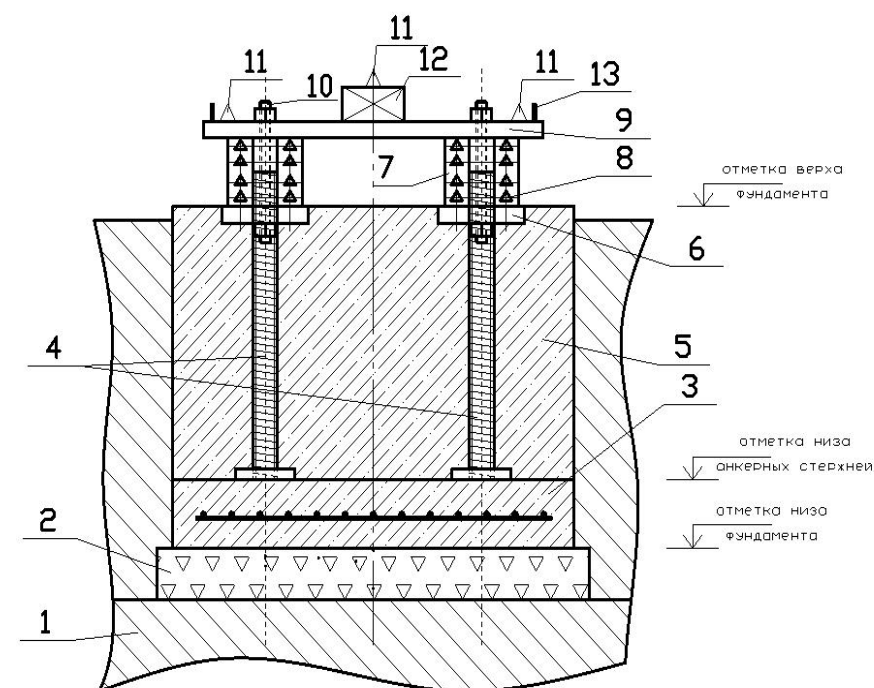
Монолитный фундамент с точным расположением анкерных стержней в момент, когда ещё не демонтирован шаблон-вибратор:
